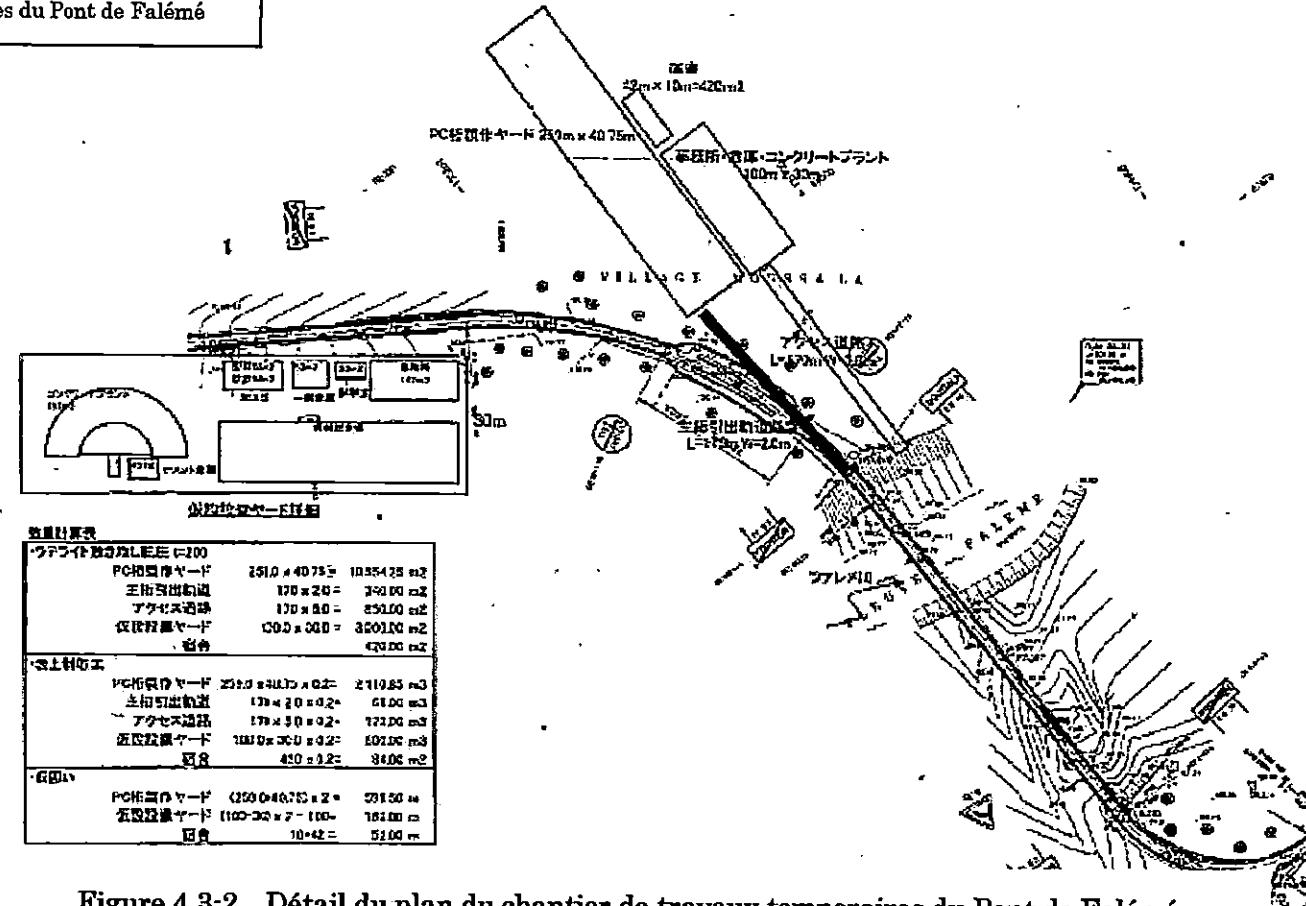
Détail du plan du chantier de travaux temporaires du Pont de Falémé
